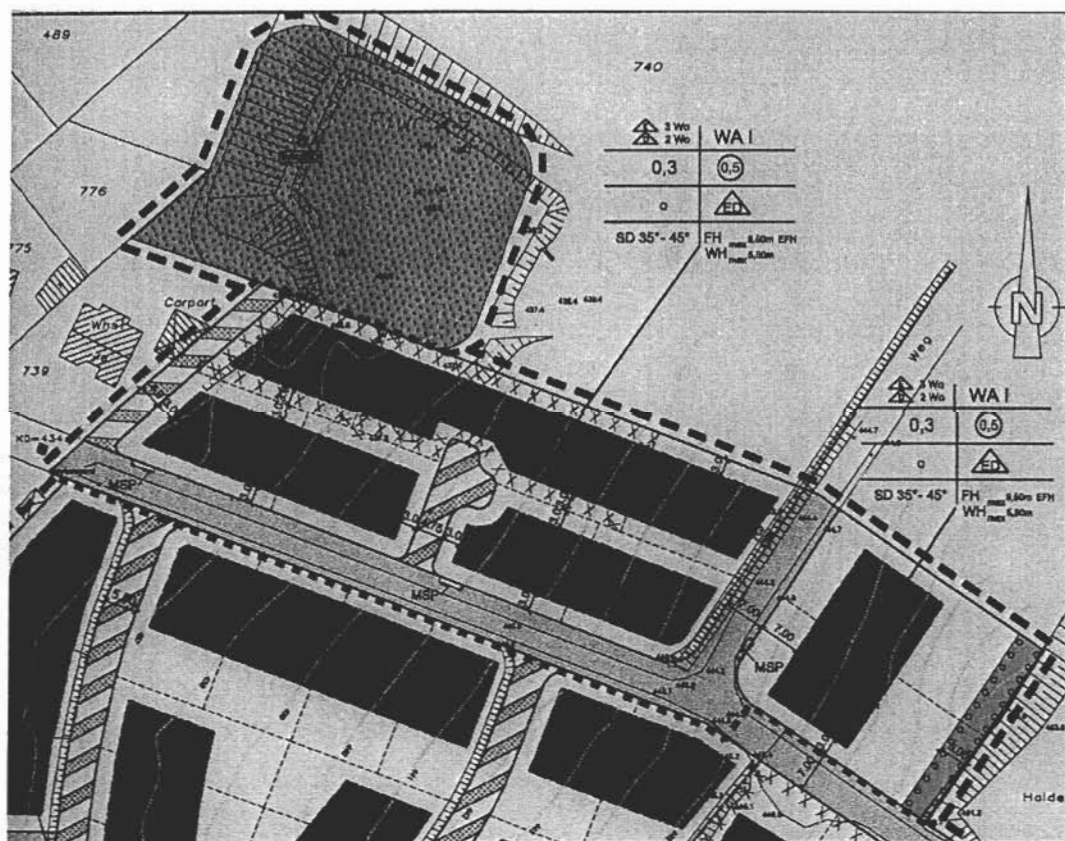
Geplante Änderung, Ausschnitt, nördlicher Geltungsbereich (Quelle: Planzeichnung B-Plan)
